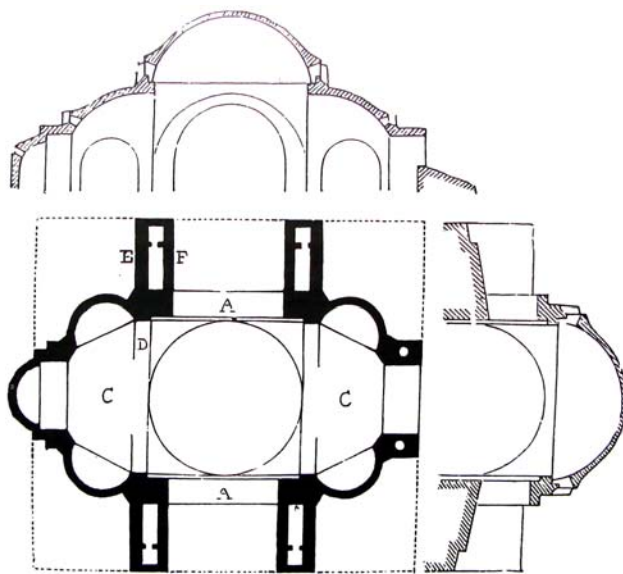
Santa Sofía de Constantinopla. Planta y secciones (Choisy)
